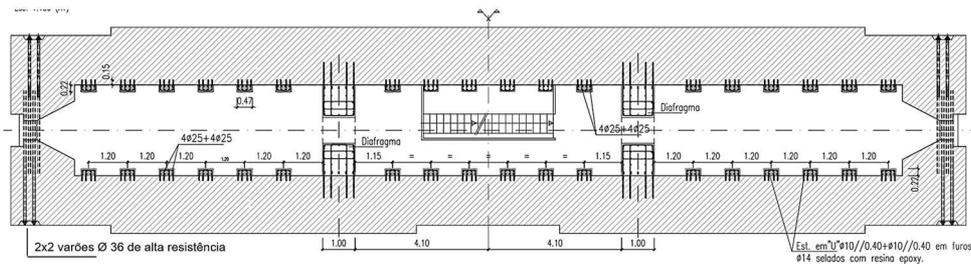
Reforço das pilastras com nervuras armadas, reforço de lintéis e paredes-diafragma.
